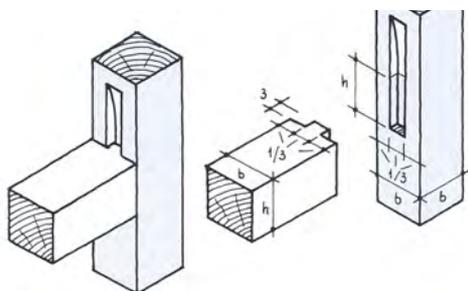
Schema Schleifzapfen aus dem Buch Anschauen, Verstärken und Auswechseln; Reparaturverbindungen der Zimmerleute Fachwerk- und Dachkonstruktionen
